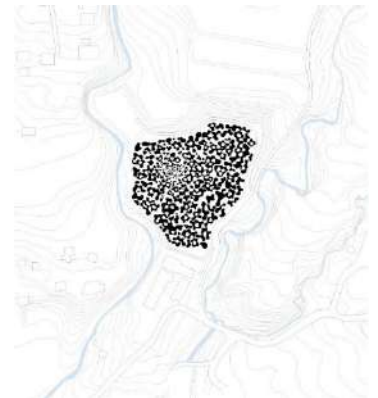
| “Art Biotop Water Garden”, Planta de Localização (Fonte: Revista Plot51, s/d).
